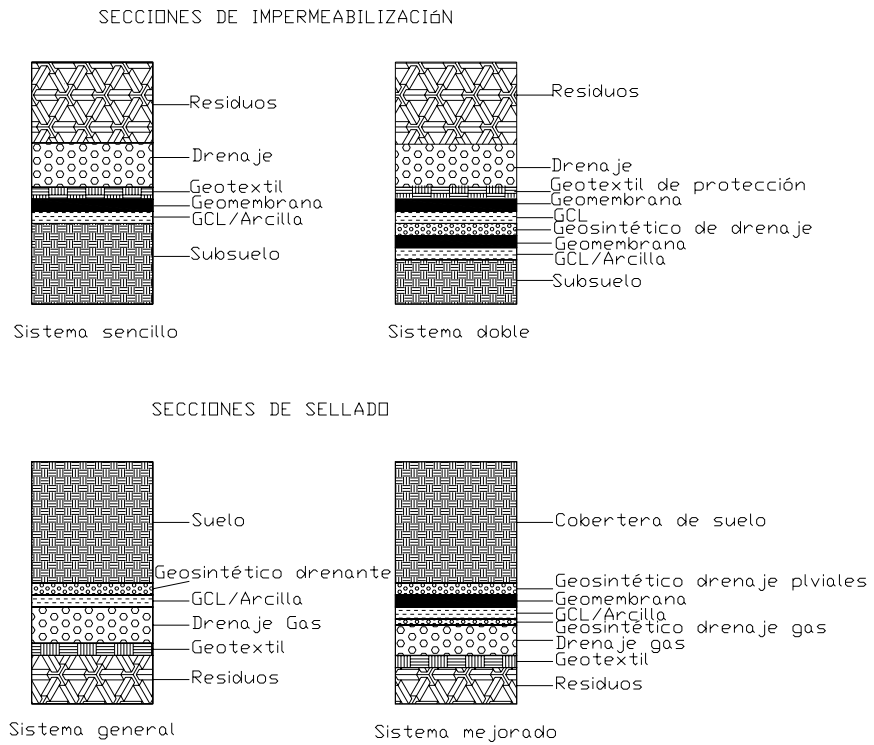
Secciones sistema impermeabilización y sellado de un vertedero de RSU
